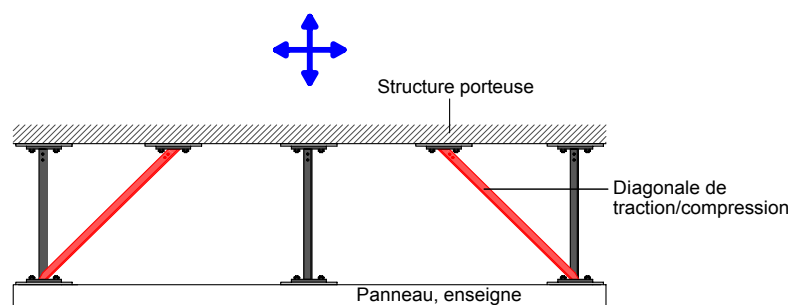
> Mesures applicables à des constructions en porte-à-faux (représentation en plan et coupe)
